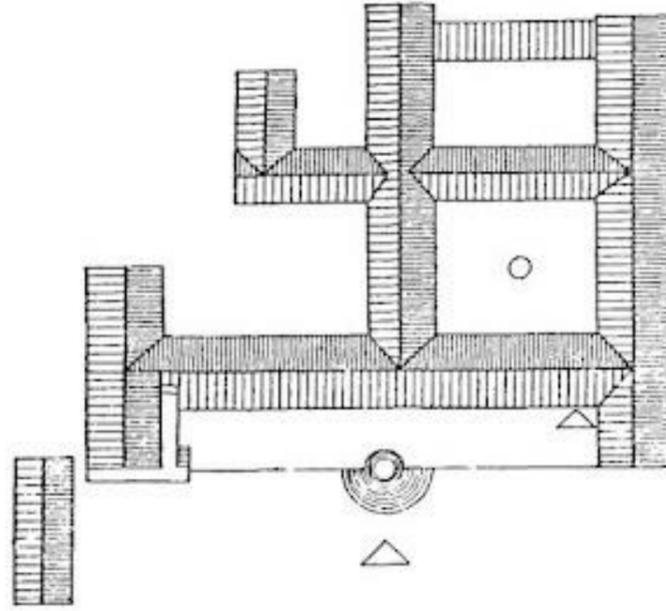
Planta Arquitectónica. Fuente André Stevens, 2014
